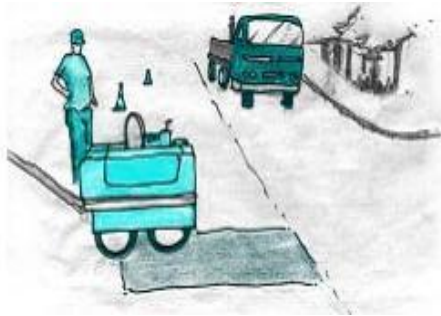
bacheo profundo, espesor diseñado de concreto - Fuente (Deterioros en pavimentos flexibles y rígidos)- Ricardo Javier Miranda Rebolledo Valdivia – Chile – 2010.
